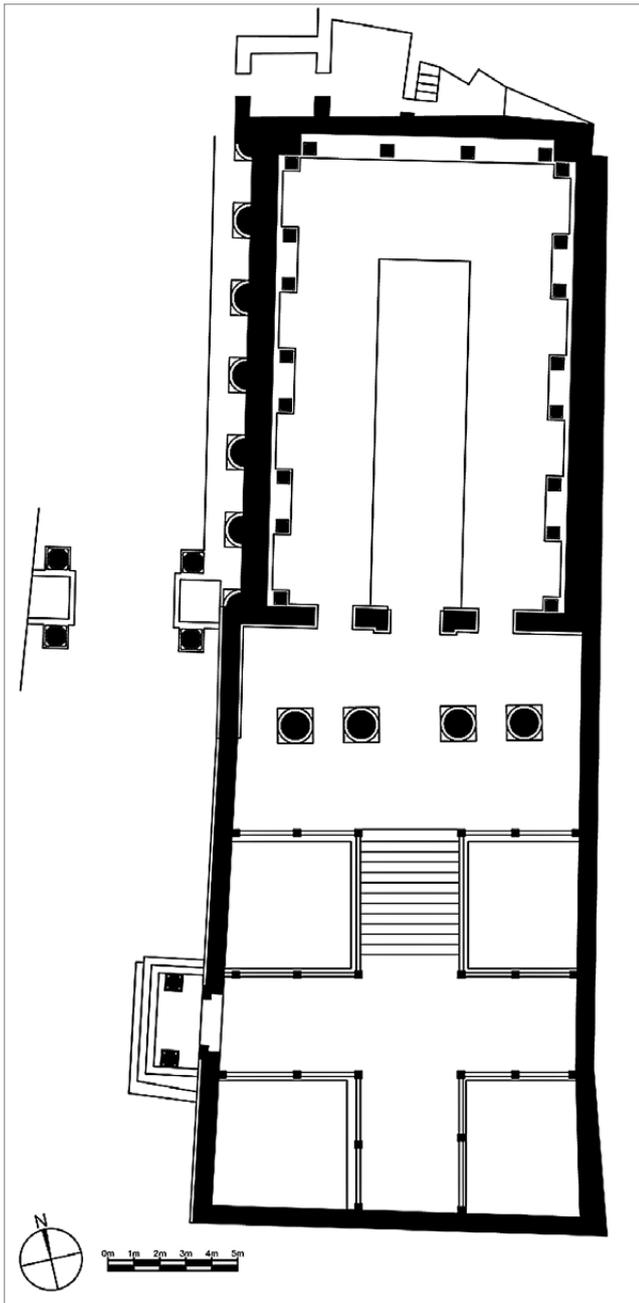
Reconstrucción de la planta del templo de las Victorias de Caracalla de Dougga.
